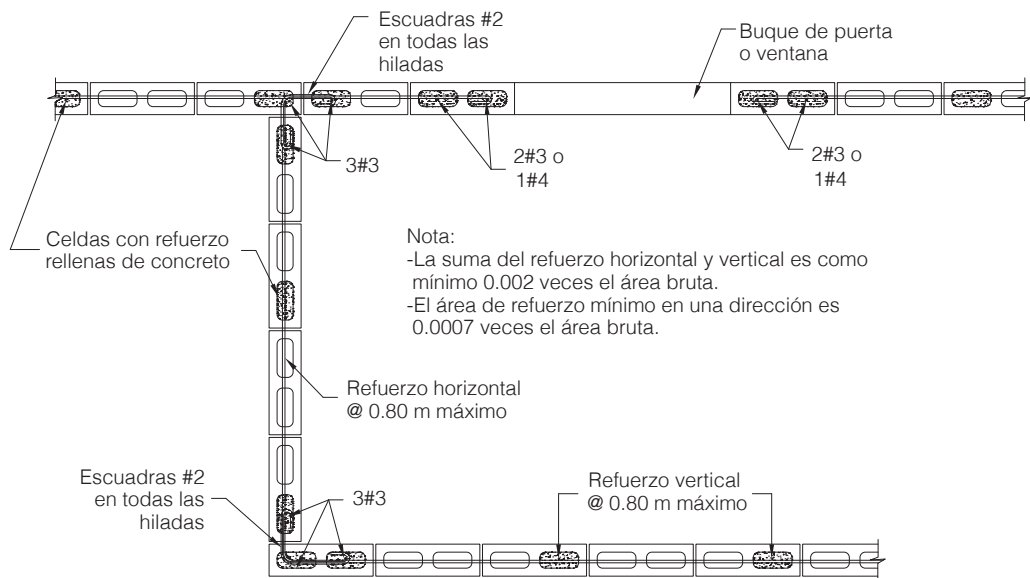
Sección de pared de mampostería con refuerzo integral.
